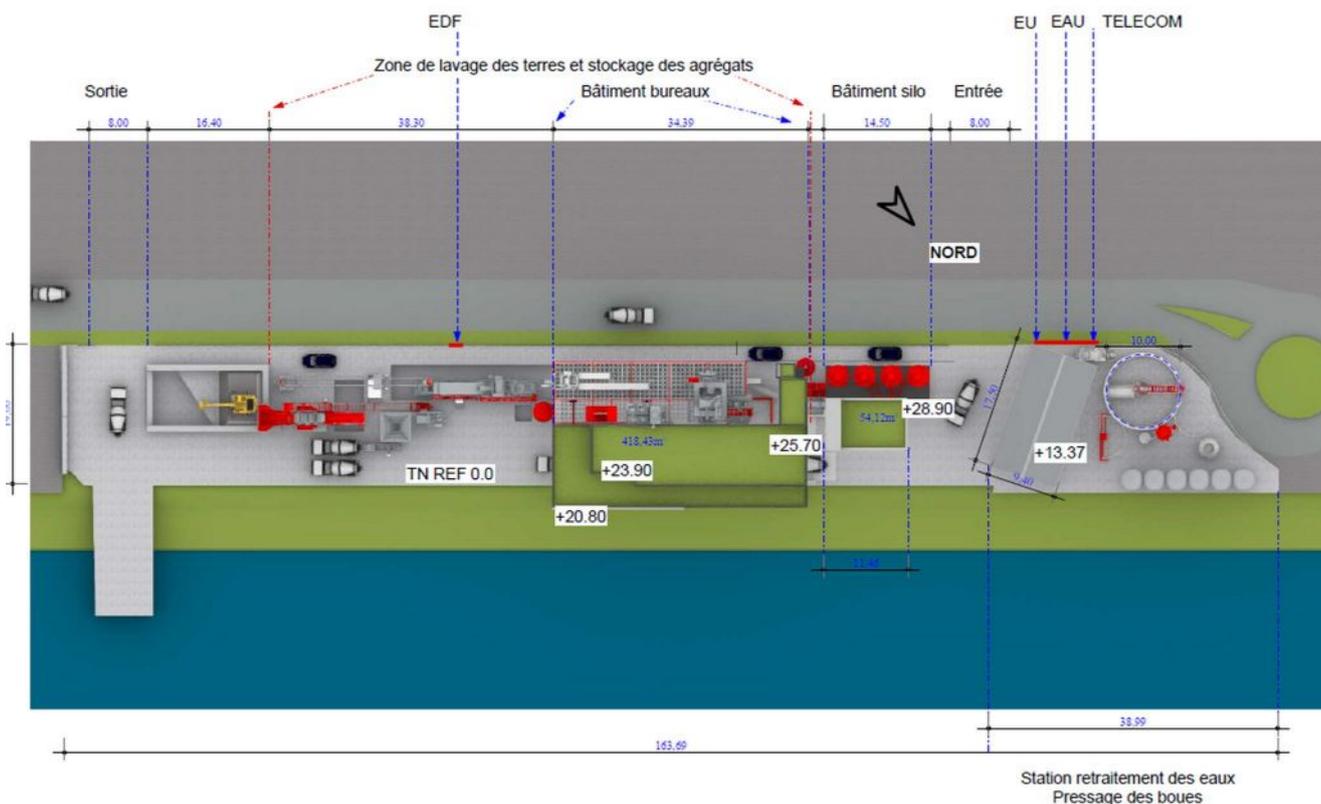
plan de masse des différentes installations présentes sur le site (source : permis de construire)
